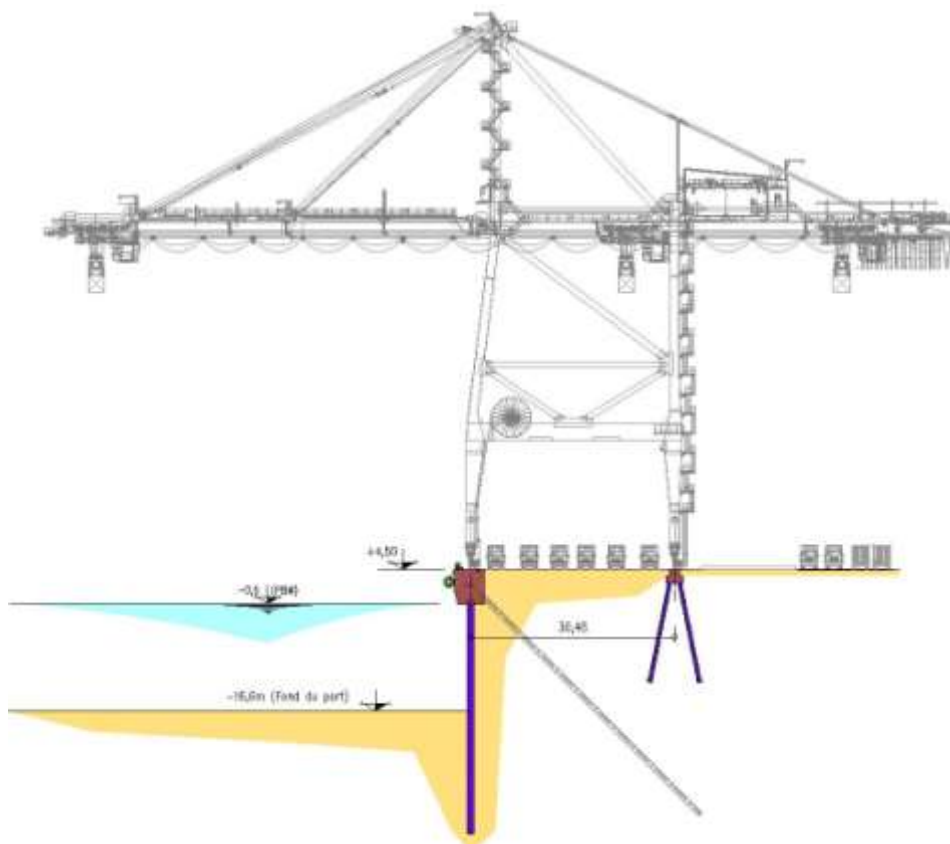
Fondations pour la voie de roulement pour portiques – Coupe transversale
